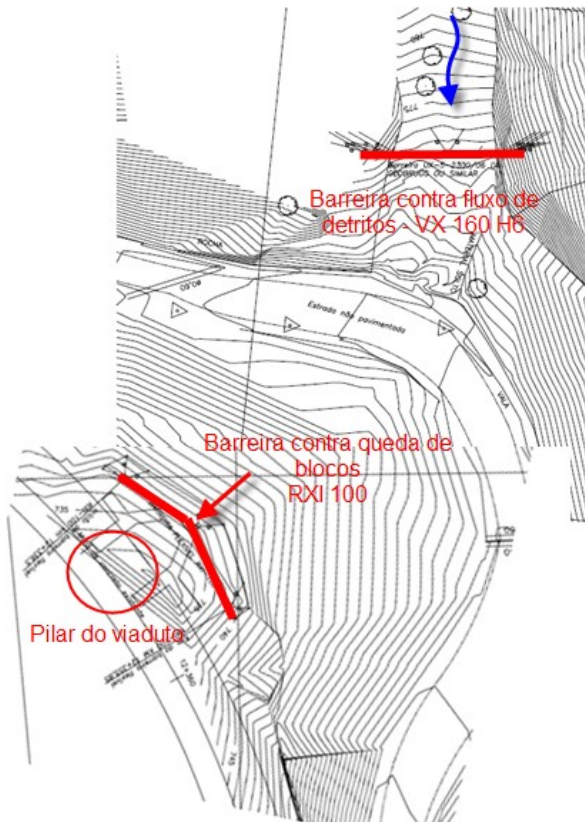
Planta baixa do ponto 6, com indicação das barreiras projetadas.
